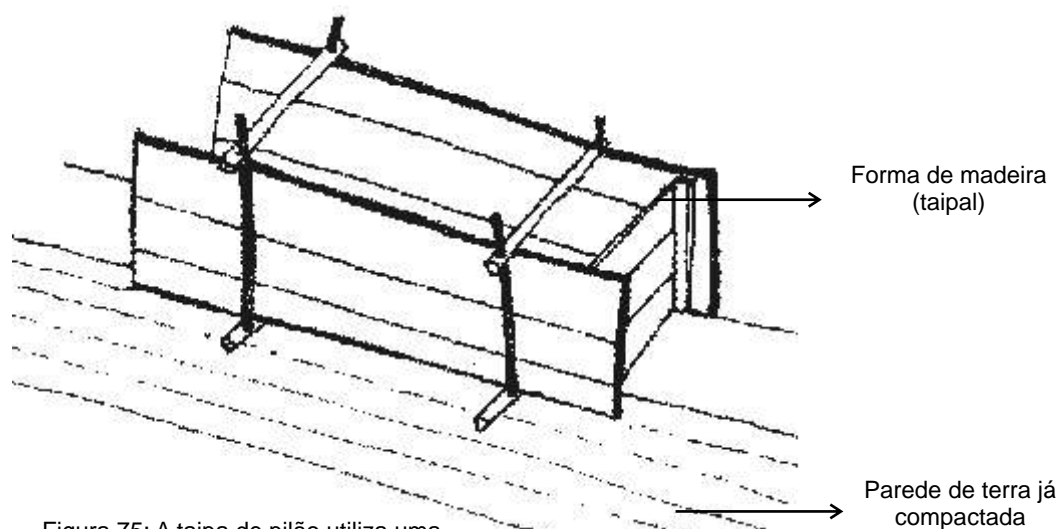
A taipa de pilão utiliza uma forma de madeira como molde para levantar as paredes.
